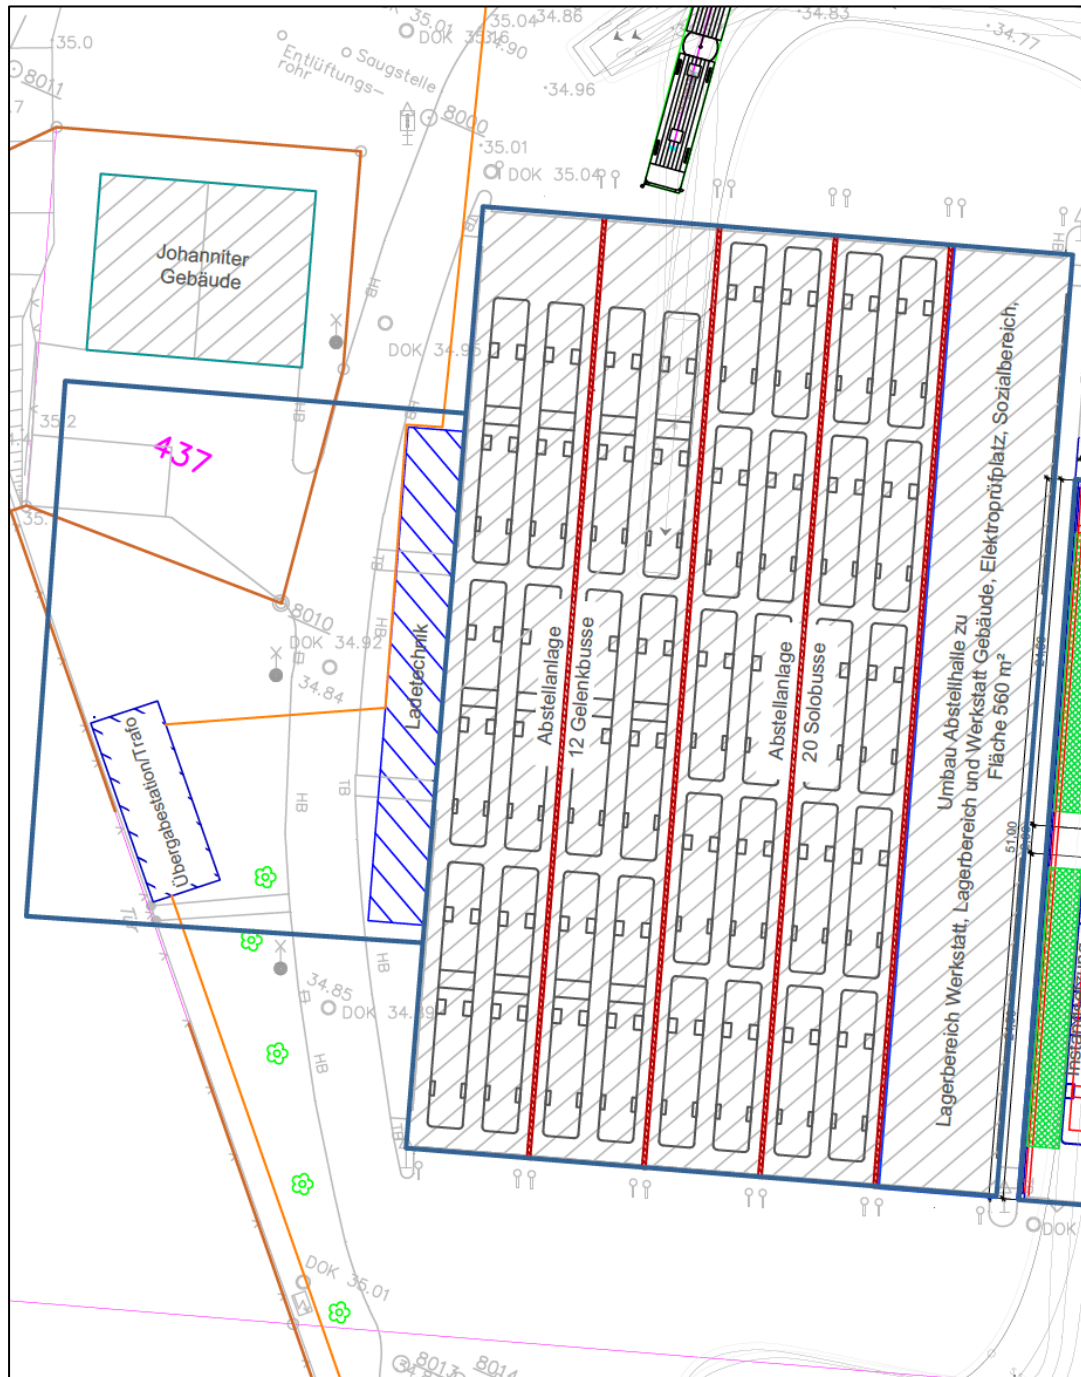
Germendorf Detailansicht Bauabschnitt 1
